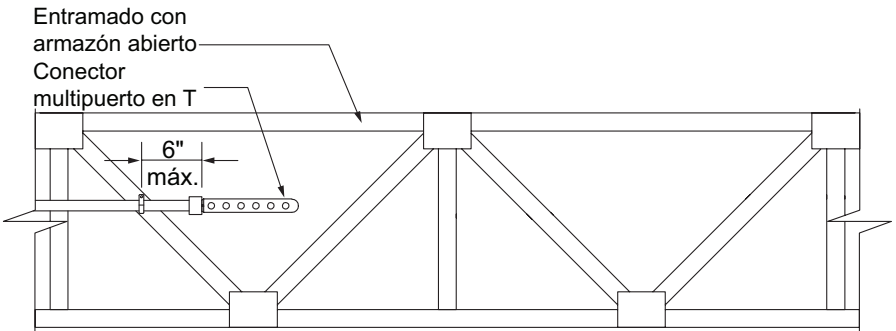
Apoyando a conectores multipuerto en T en entramados de madera con armazón abierta
